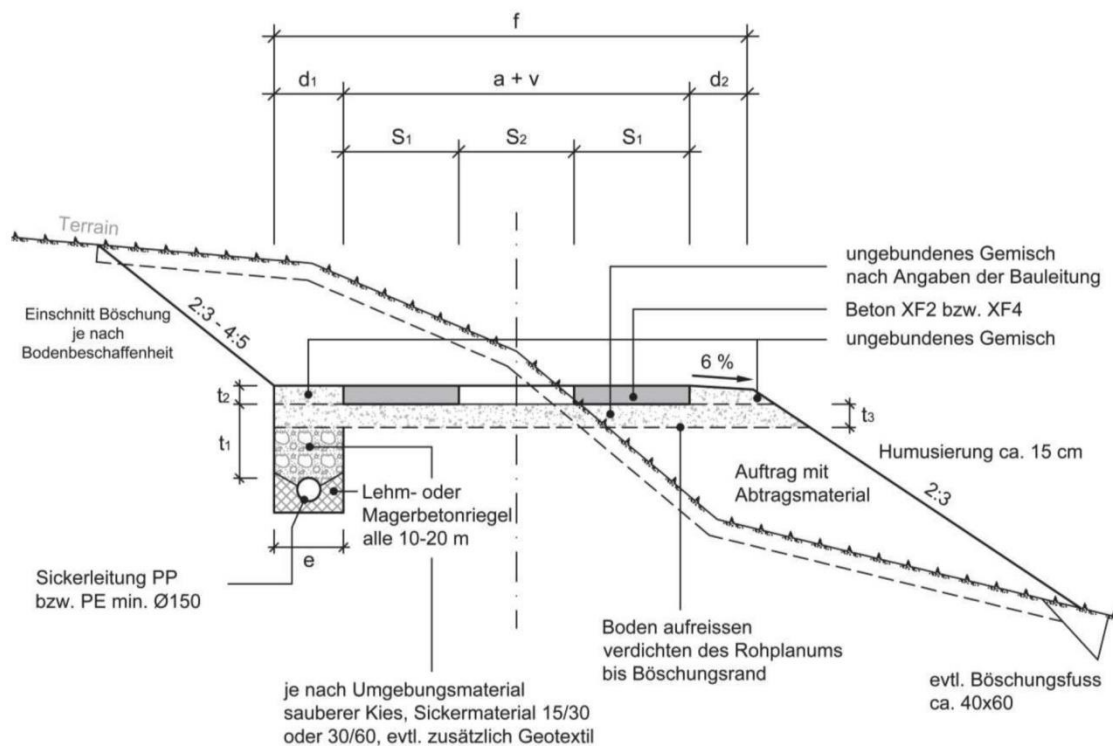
Starrer Oberbau mit Betonspuren – Einschnitt und Auffüllung (mit Entwässerung).
